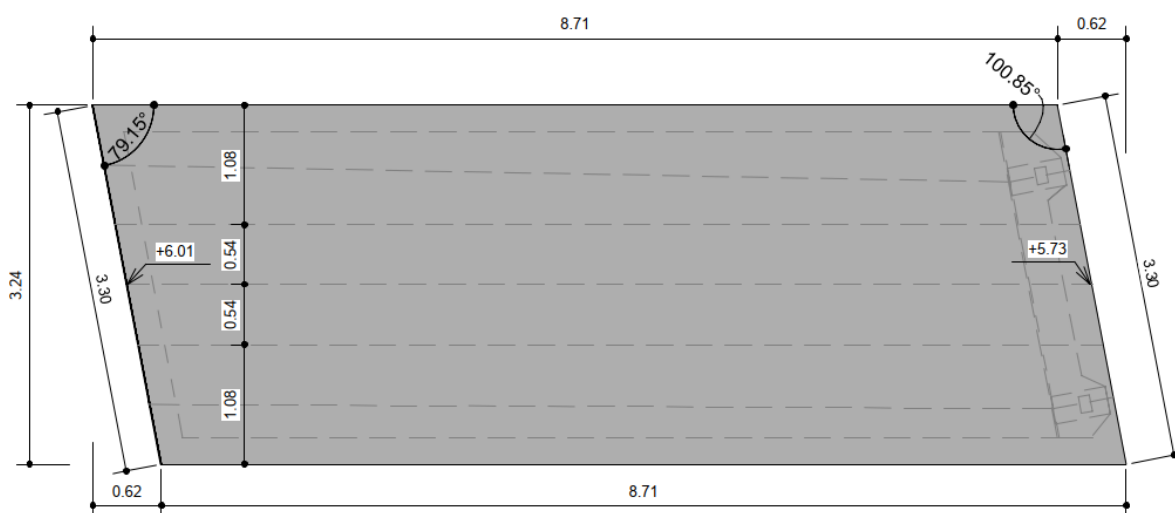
Vue en plan du platelage de type 8 (platelage d'extrémité rive droite)
